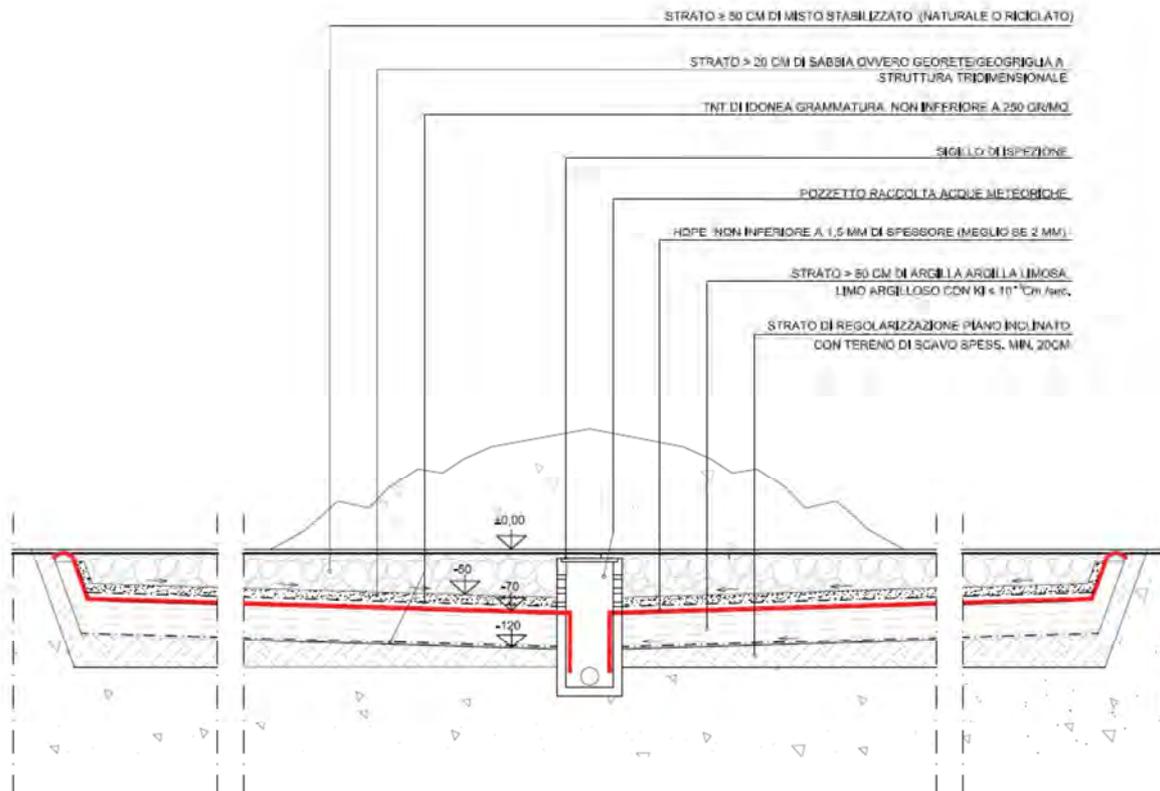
Pavimentazione piazzola stoccaggio materiale in uscita dall'impianto di recupero rifiuti
